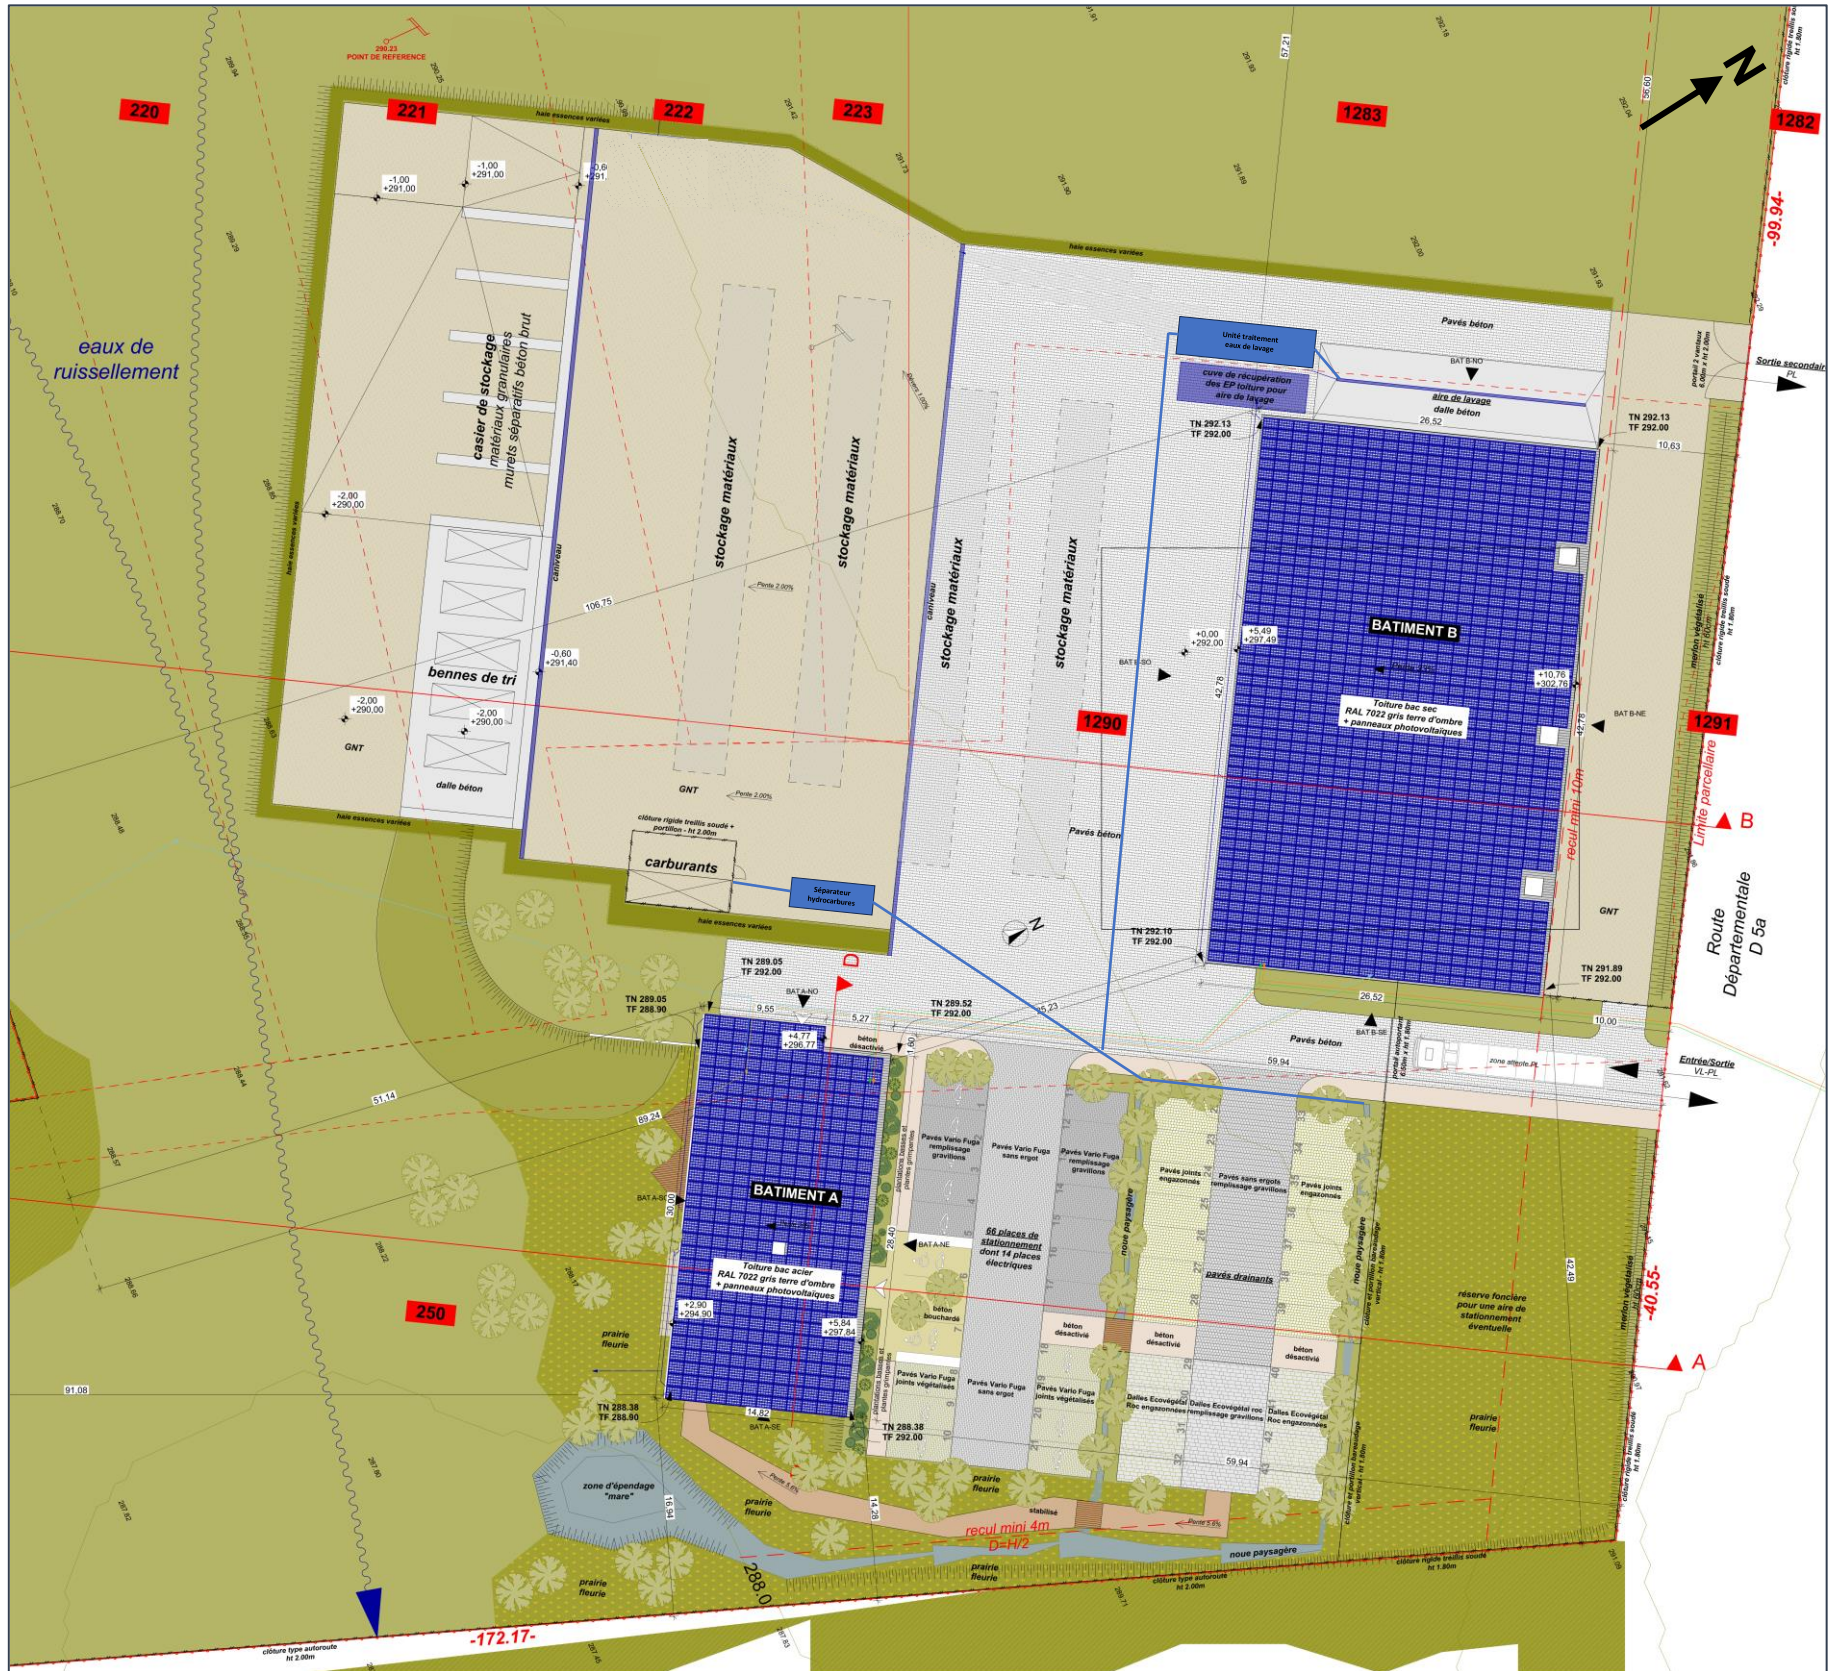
PLAN GÉNÉRAL DU PROJET D'AMÉNAGEMENT
